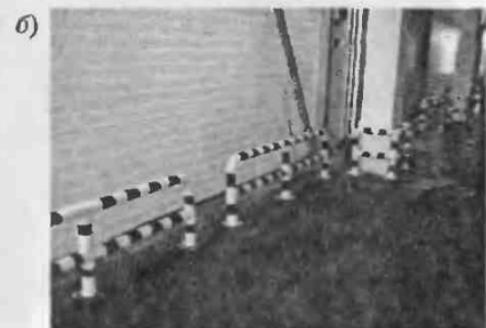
Дополнительное оборудование к сборной холодильной камере:
